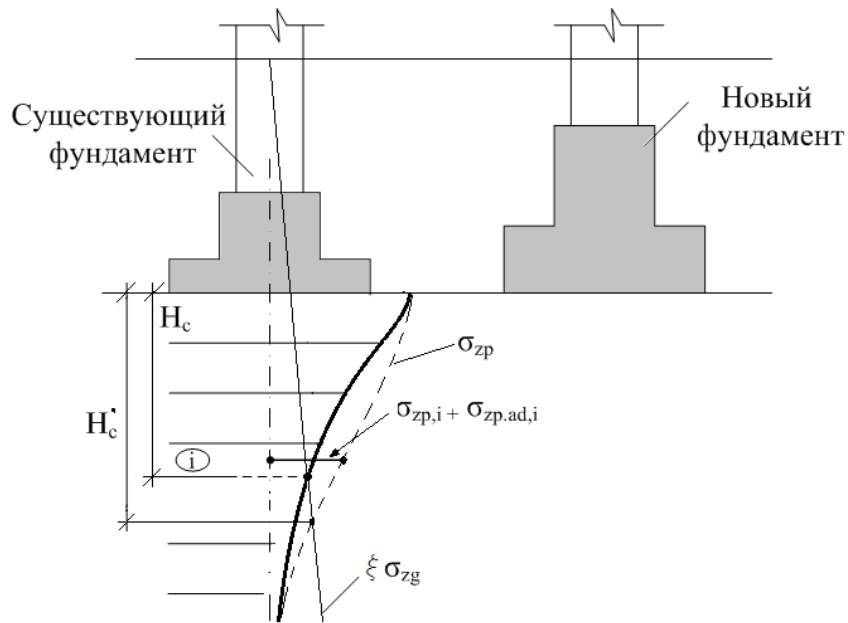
Расчетная схема к определению осадки от дополнительной нагрузки
